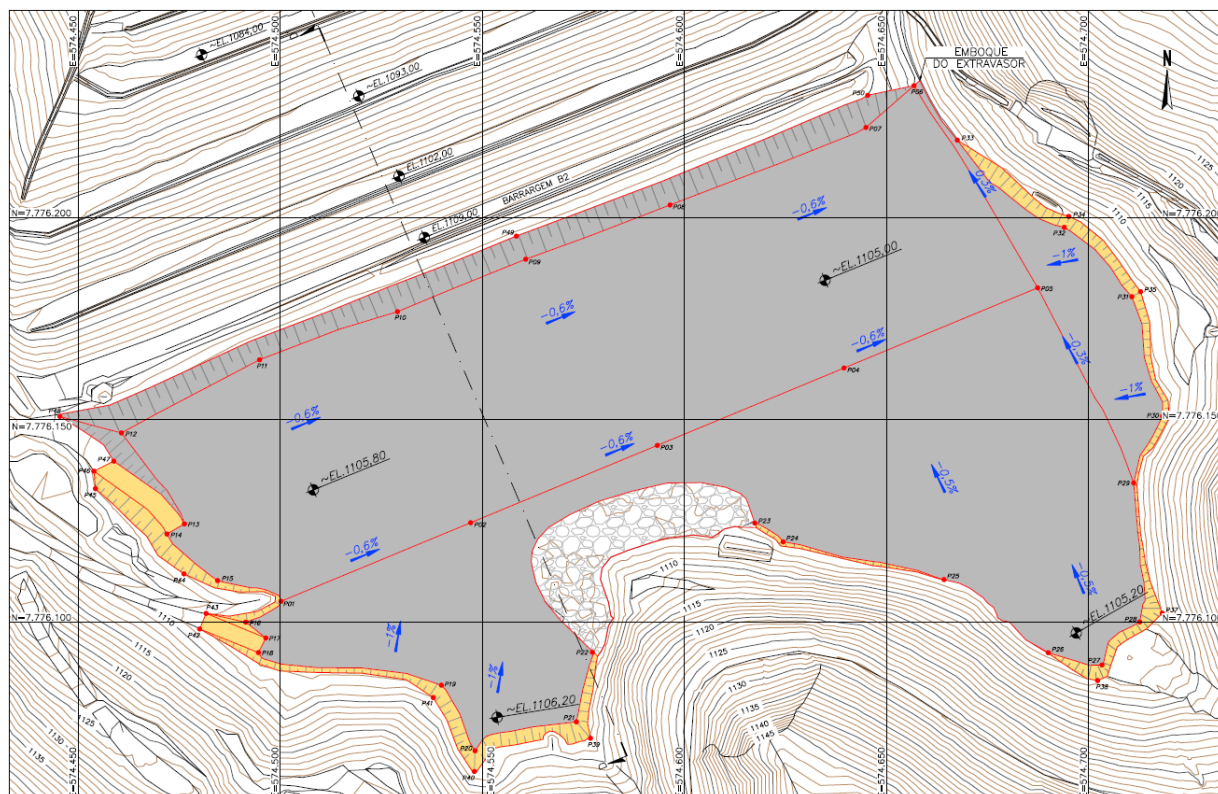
Escavações complementares - Planta (Fonte: IPE.OP.DE.8000.GT.20.1414).
